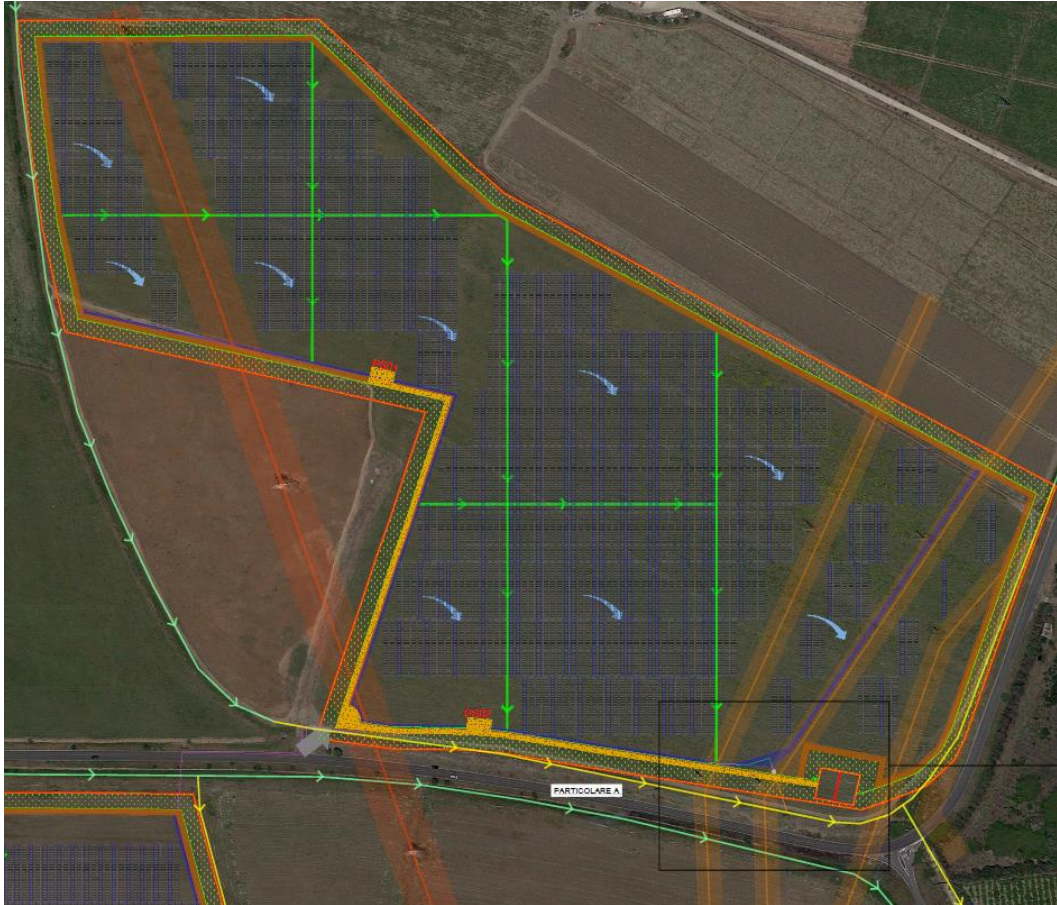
Sistema di drenaggio acque meteoriche – Planimetria Area Nord – Stralcio tavola progettuale
